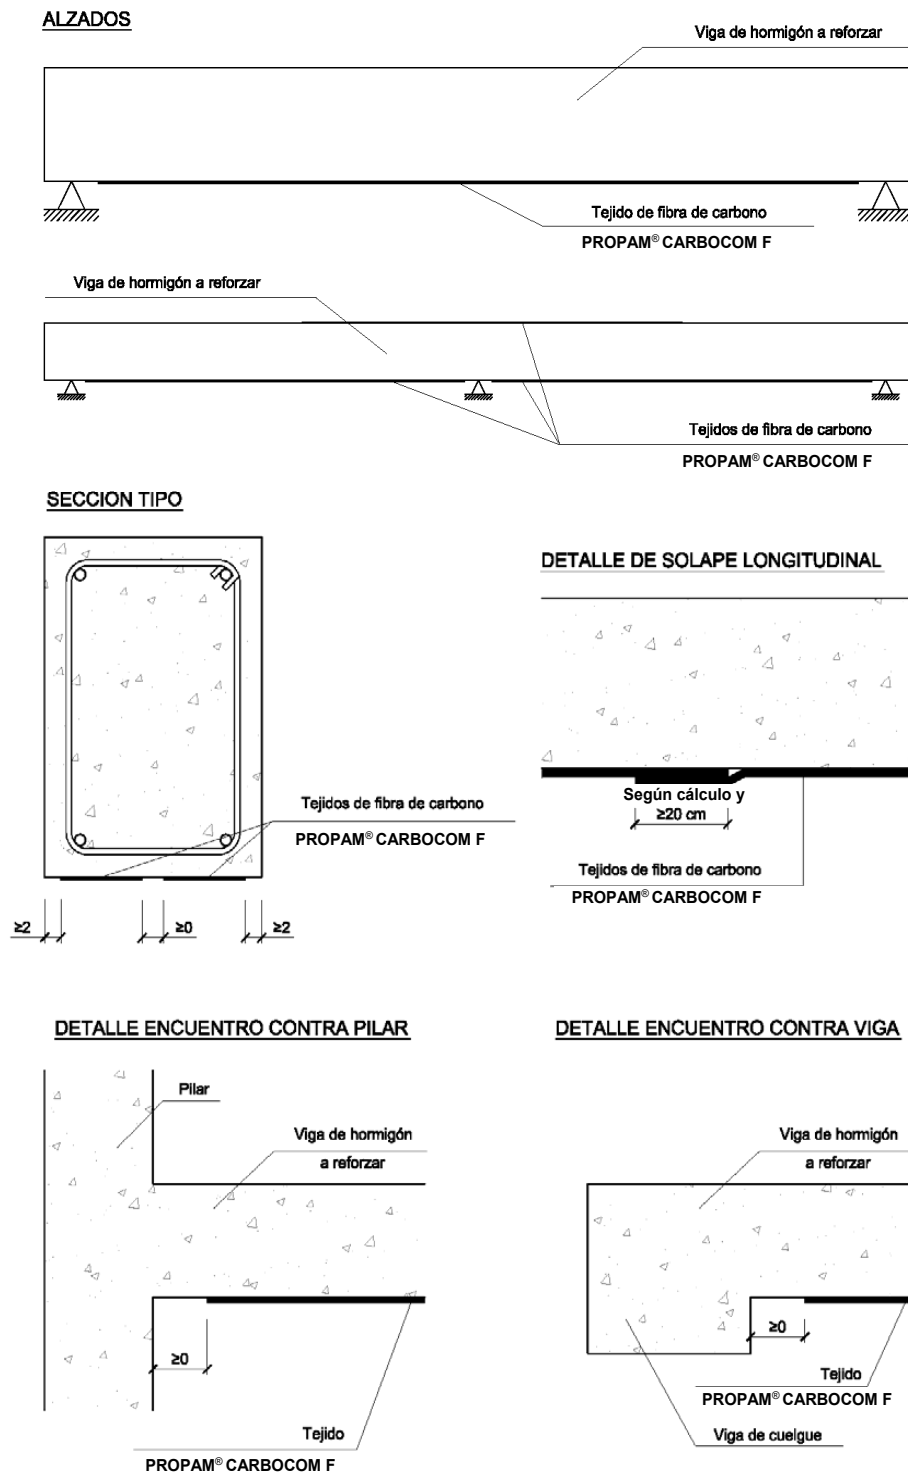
Sistema PROPAM® CARBOCOM P para el refuerzo a tracción en vigas
